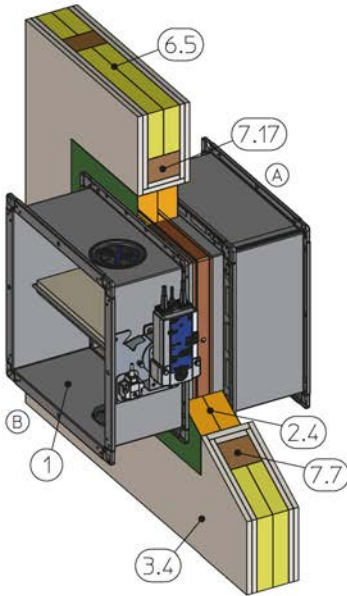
Trockeneinbau mit Mineralwolle in Holzfachwerkwand
